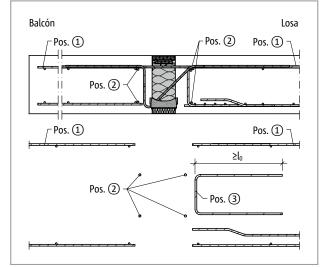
Schöck Isokorb® T tipo K-M1 hasta M11: Armadura in situ en caso de apoyo indirecto
